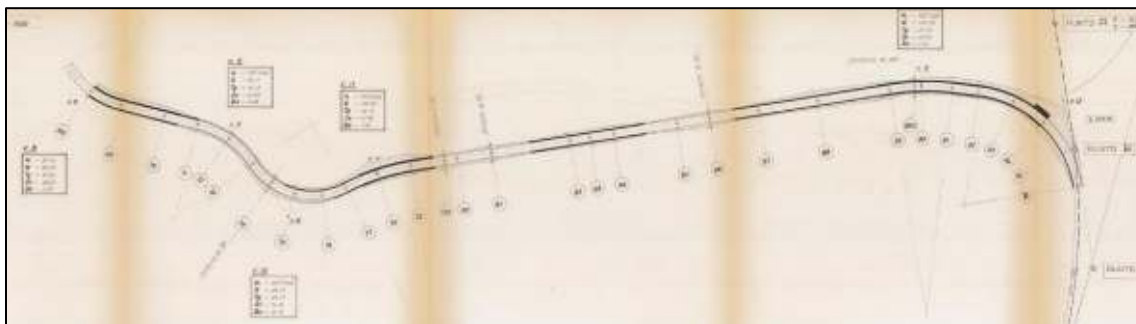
Strada di accesso al coronamento – Planimetria tra la sezione 68 e la spalla destra dello sbarramento
